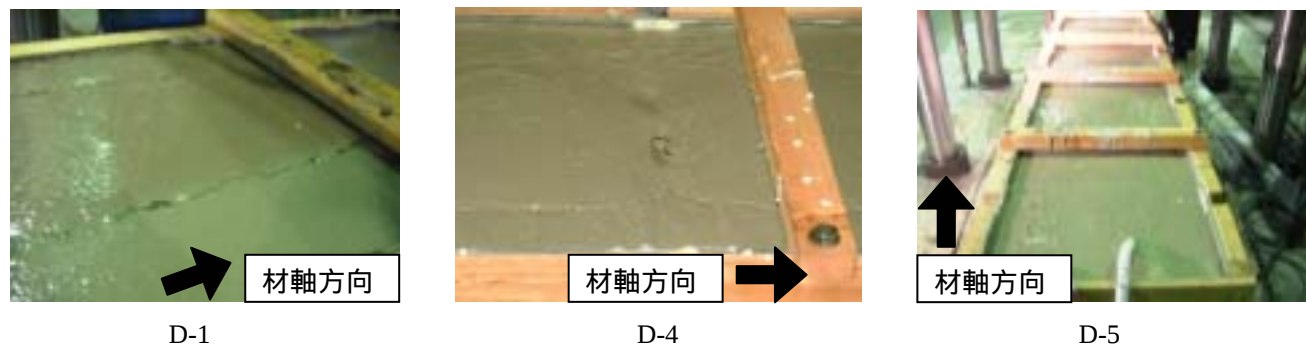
繰返し載荷開始後のひび割れ状況
